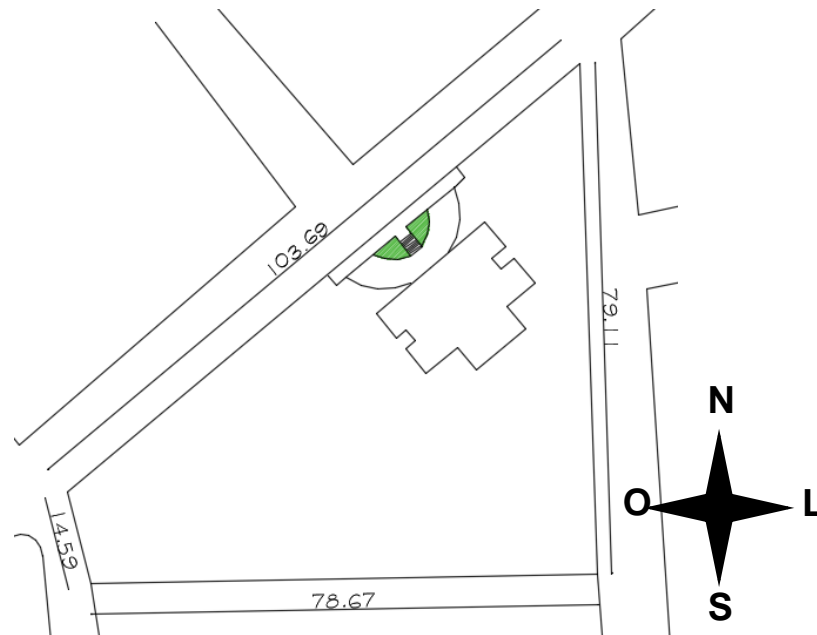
Planta do terreno do projeto paisagístico (escala não indicada)
